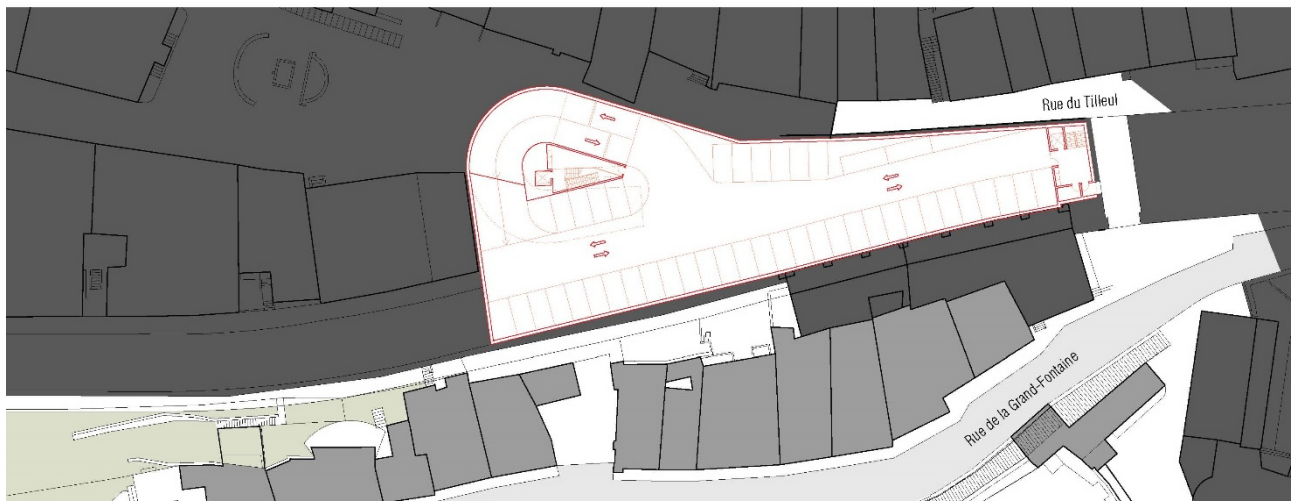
Plan du niveau de l'entrée et étage type du parking du Petit-Paradis
